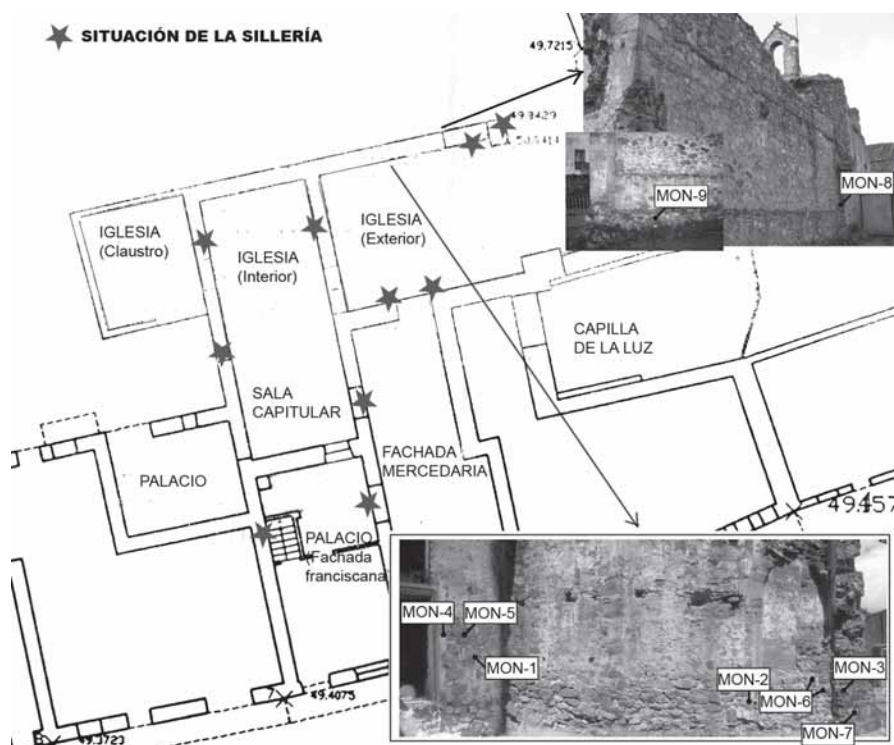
Plano de los sectores arqueológicos de la excavación. Situación de la sillería del Monasterio y de la toma de muestras de mampostería en la fachada de la Iglesia Exterior (Modificado del arquitecto Félix Gordillo, proyecto A.R.I.)
